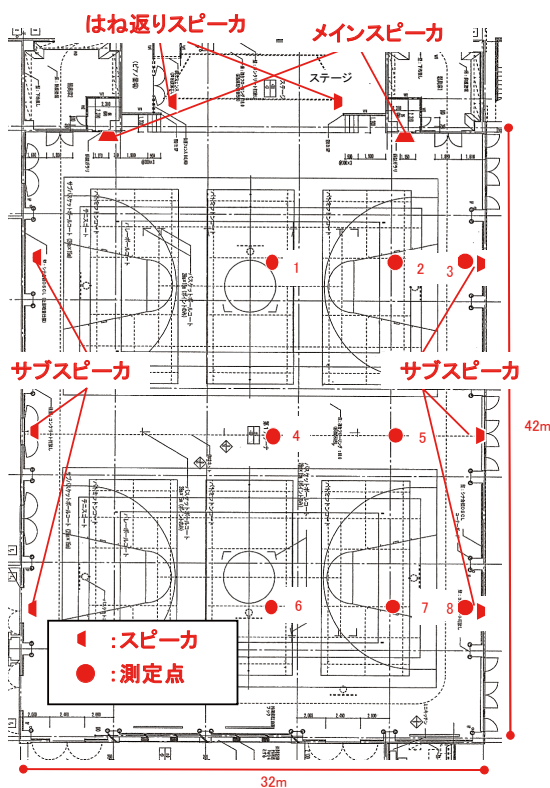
B 高校講堂兼体育館 平面図、スピーカおよび測定点位置
